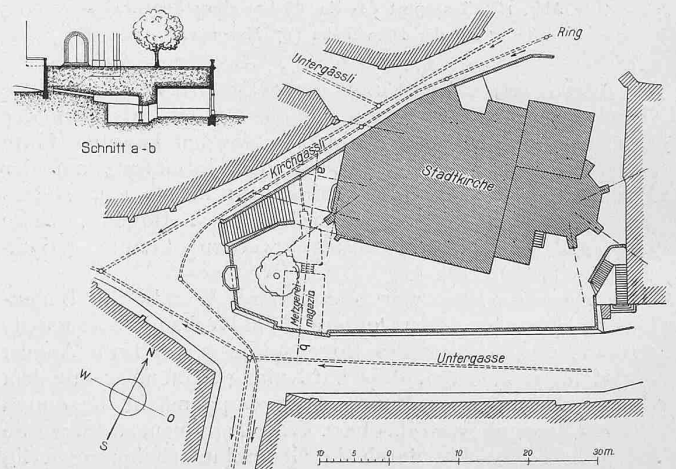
Lageplan und Schnitt a-b. — Masstab 1 : 1000.
